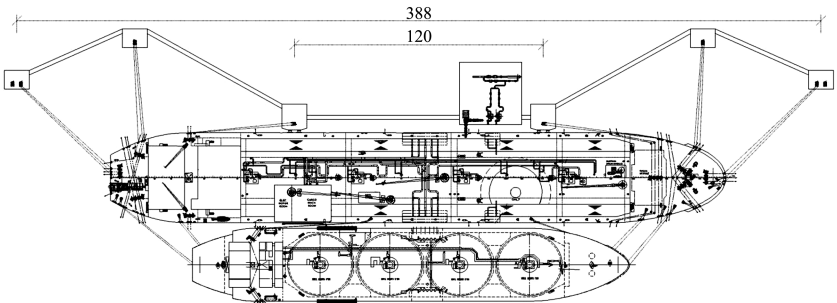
17 万 m<sup>3</sup> FSRU 船舶平面图（单位：m）
